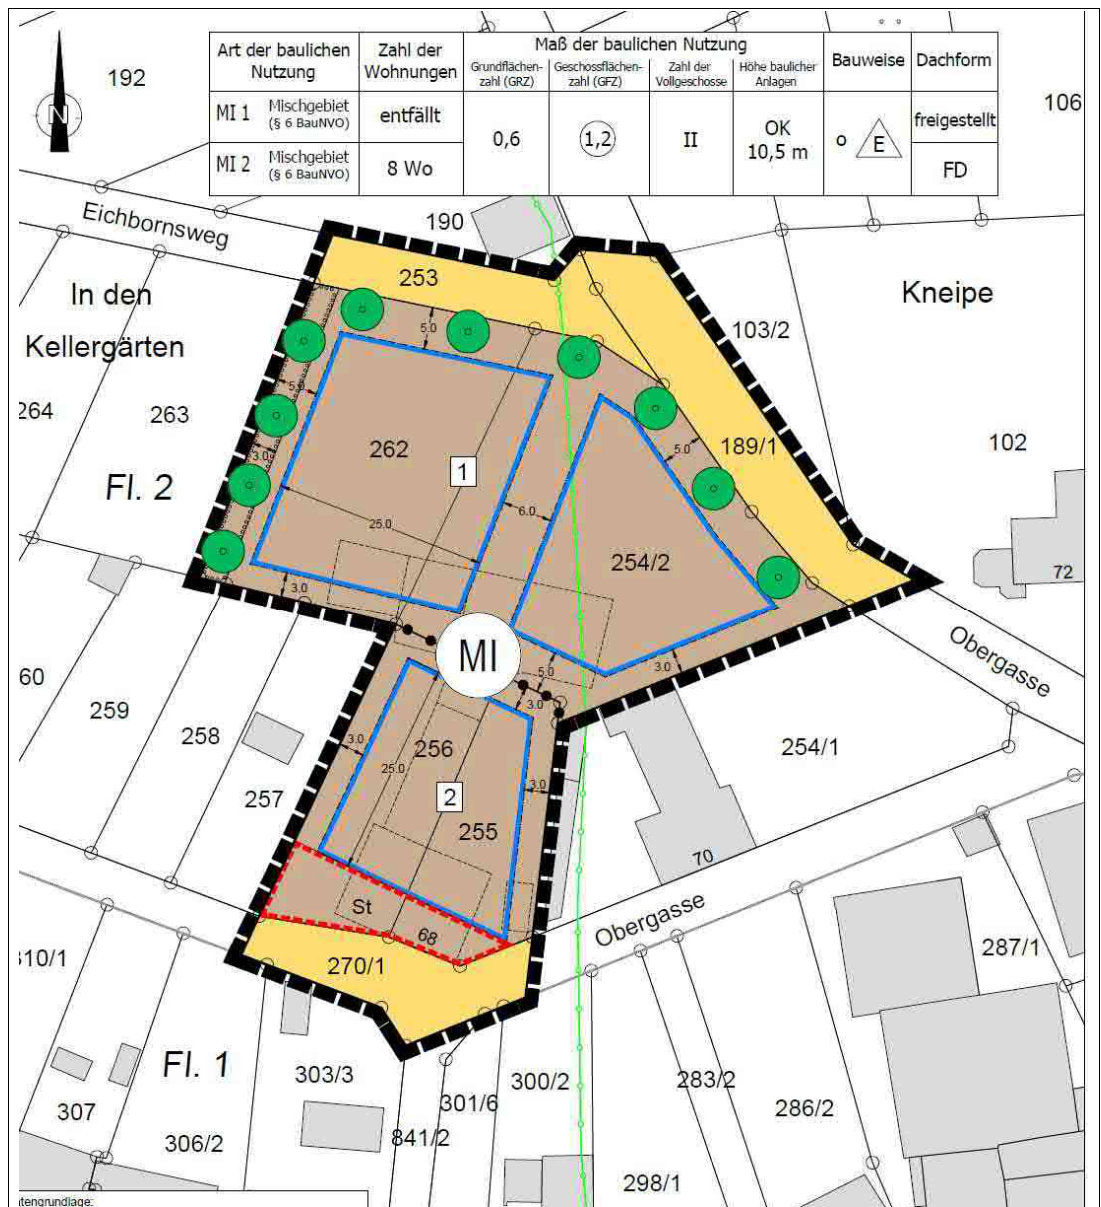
Entwurf Bebauungsplan (Ausschnitt).
